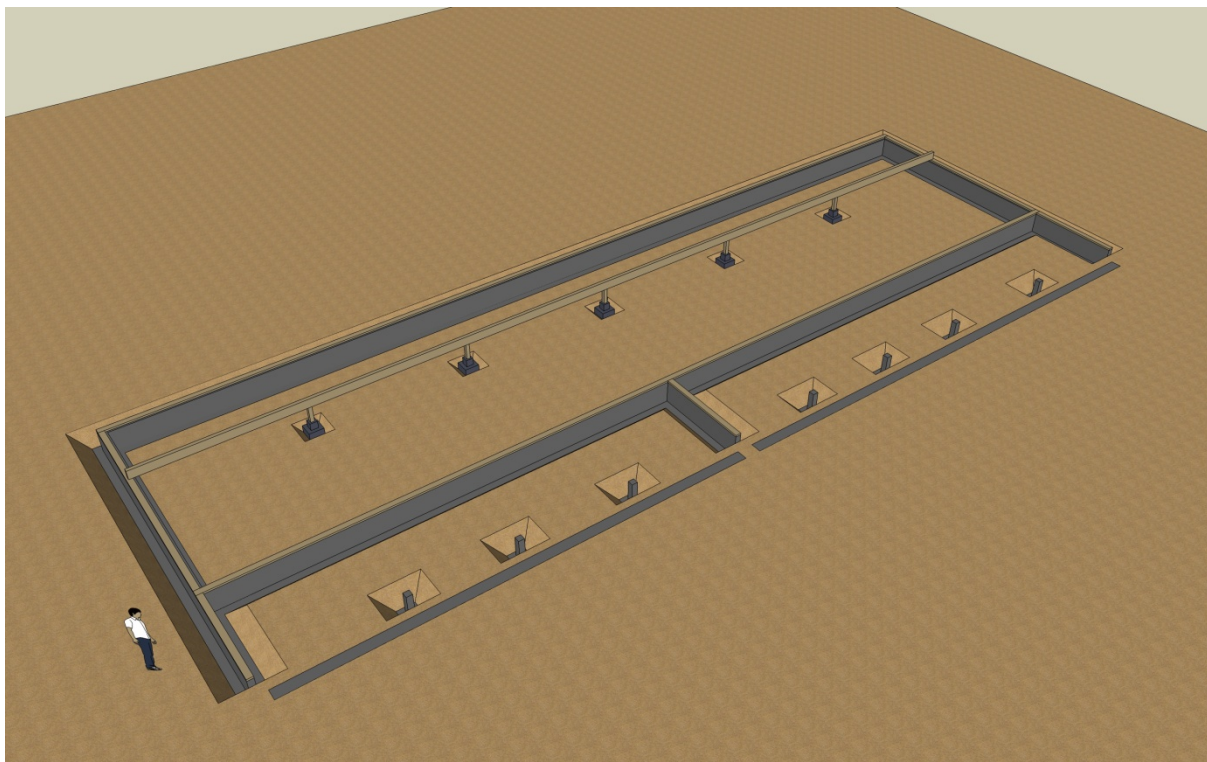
Execução das fundações (fundação corrida e sapatas), frechal e viga.
